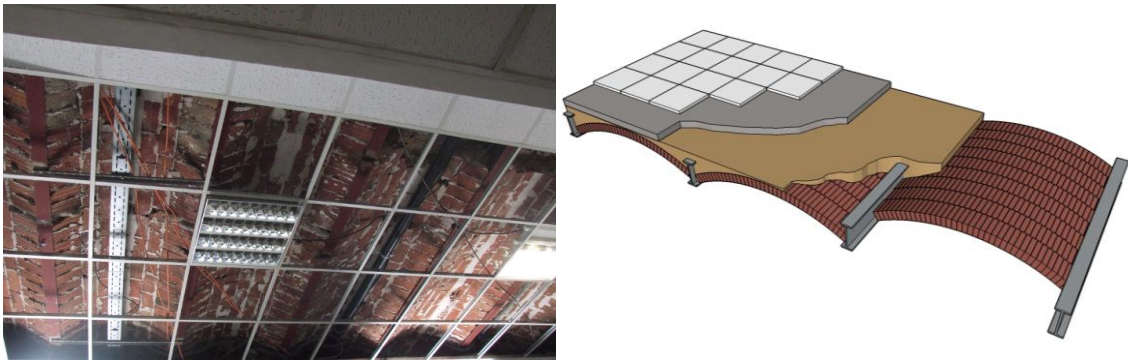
Exemple d'un plancher en voutain (Crédit photo : Souami M.A., Djennane W.).
